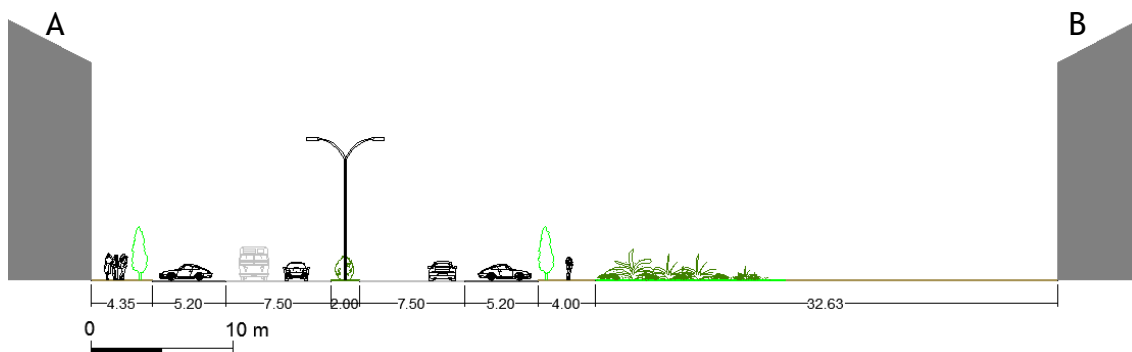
Perfil transversal da Alameda da Europa (adimensional)
